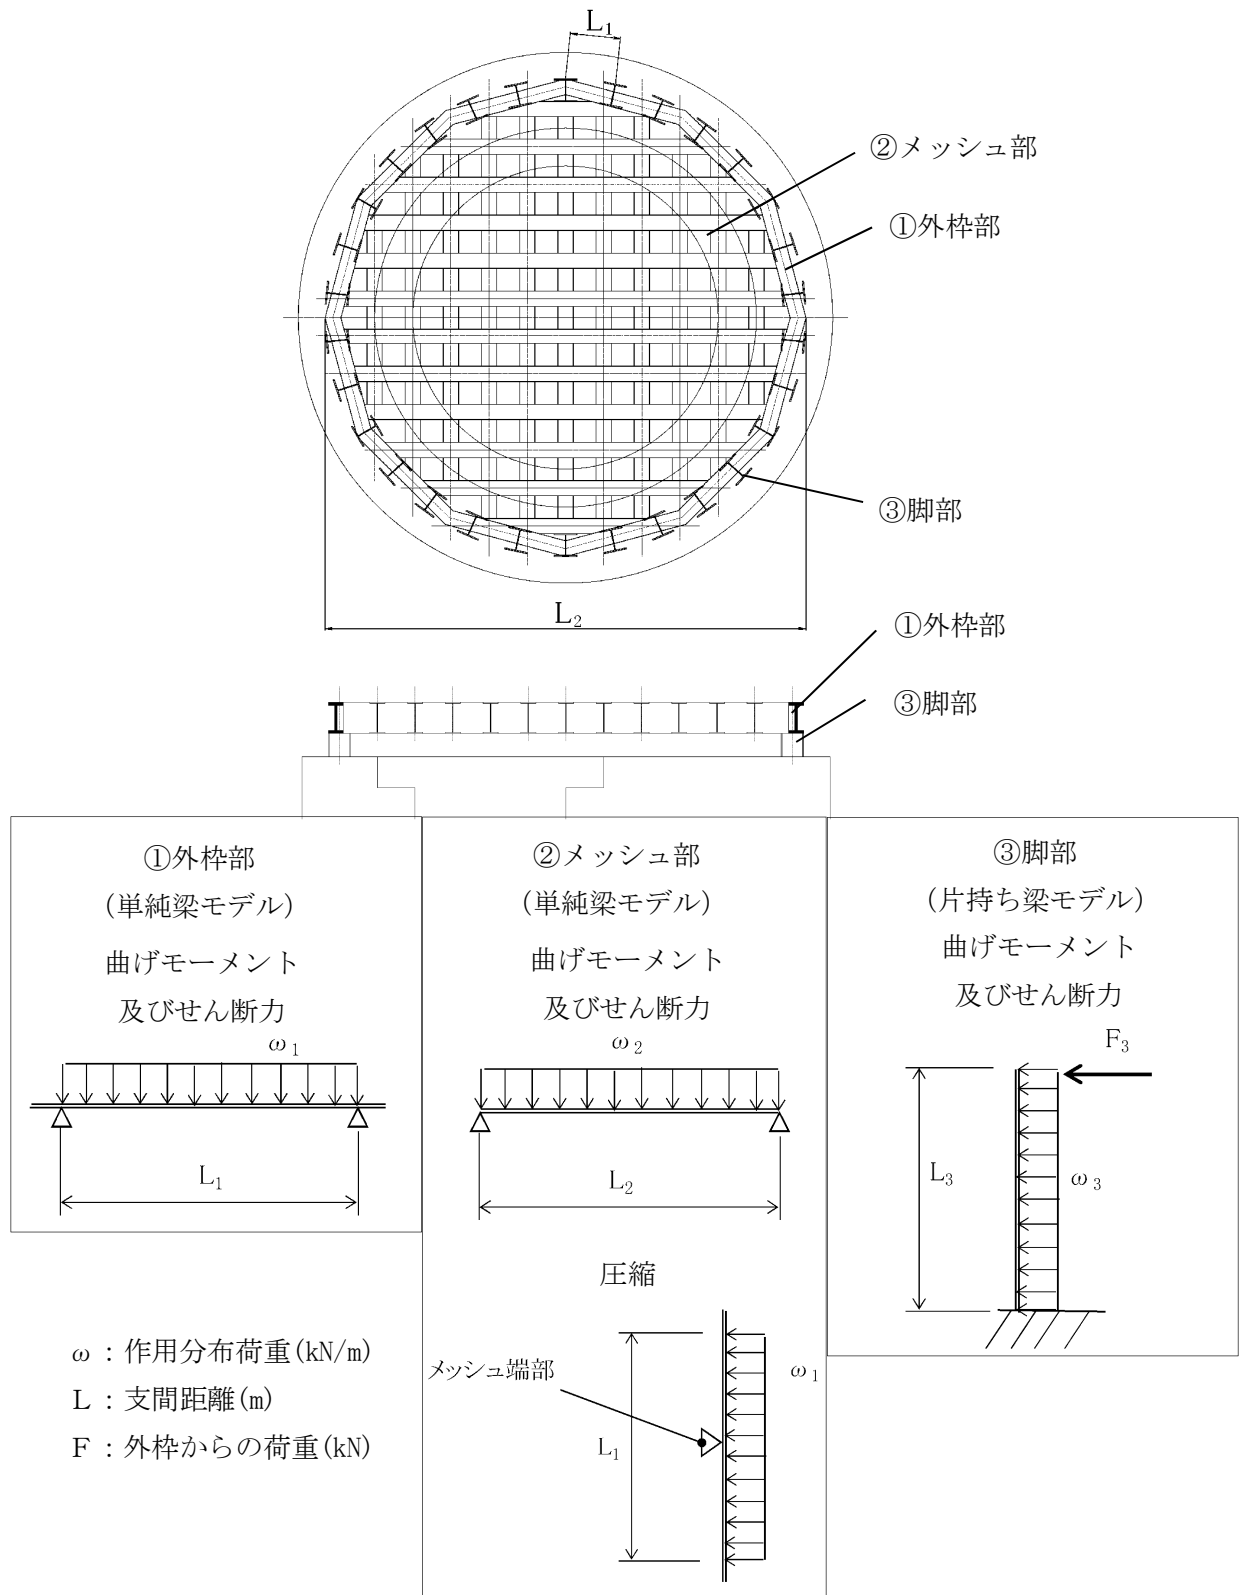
上段鋼製蓋平面図及び計算モデル図
